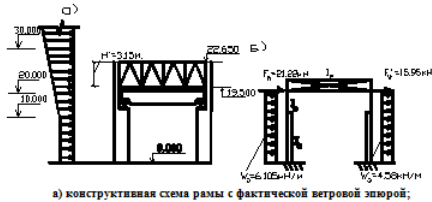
К определению ветровых нагрузок (нагрузка № 3)
